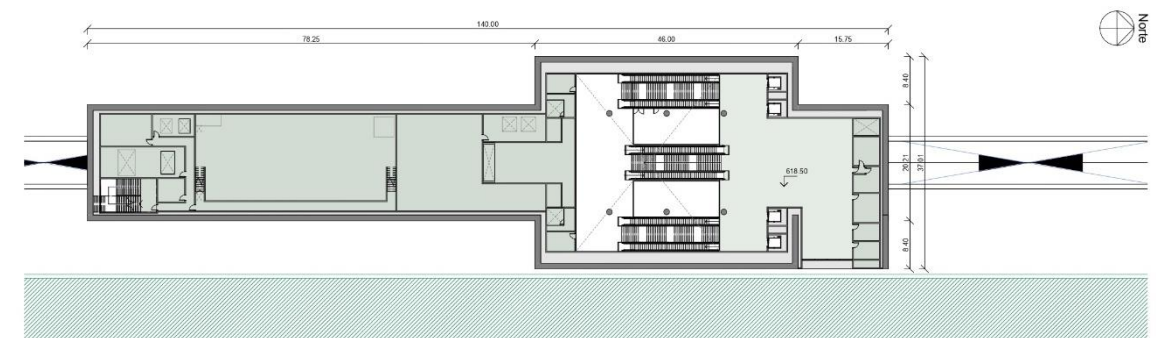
Estación Barajas T4 _Planta Vestíbulo
